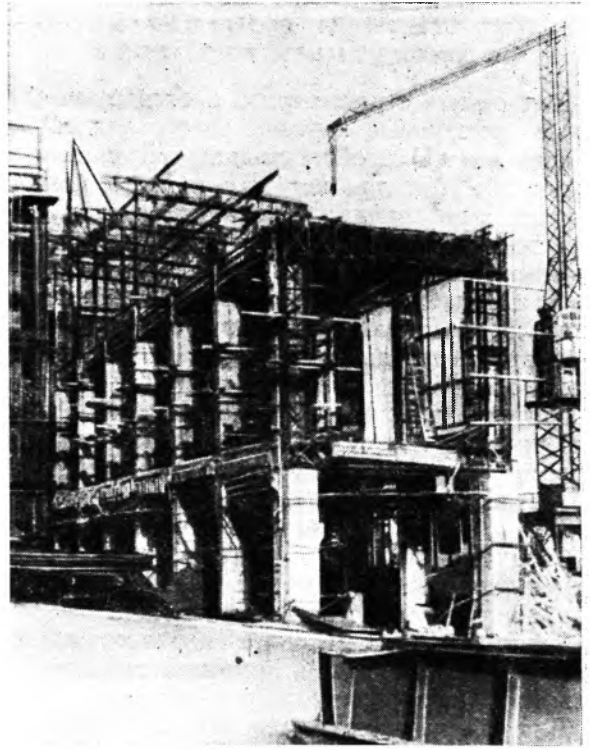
Возведение железобетонных конструкций бункерного отделения электростанции.
